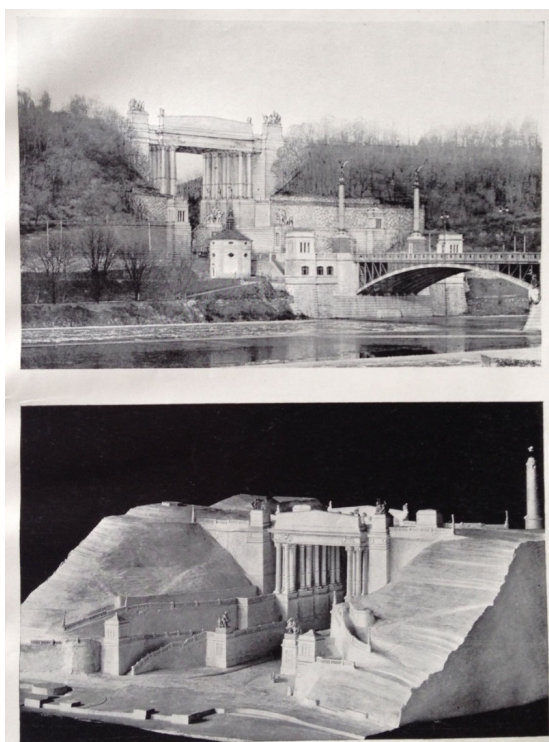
„Armovaný beton“ - Návrh F. Kvetinka, Kotka a Polívky. Zdroj: <http://www.Letenskaplan.webgarden.cz/rubriky/budovy-stavby/nerealizovano/felix-kveting-1909-tunel-na>
